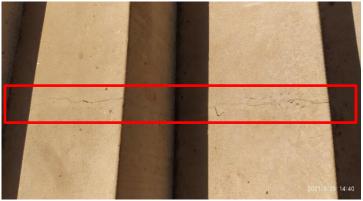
Fisuras en estructura de gradería de la cancha – OCI 25-03-2021
